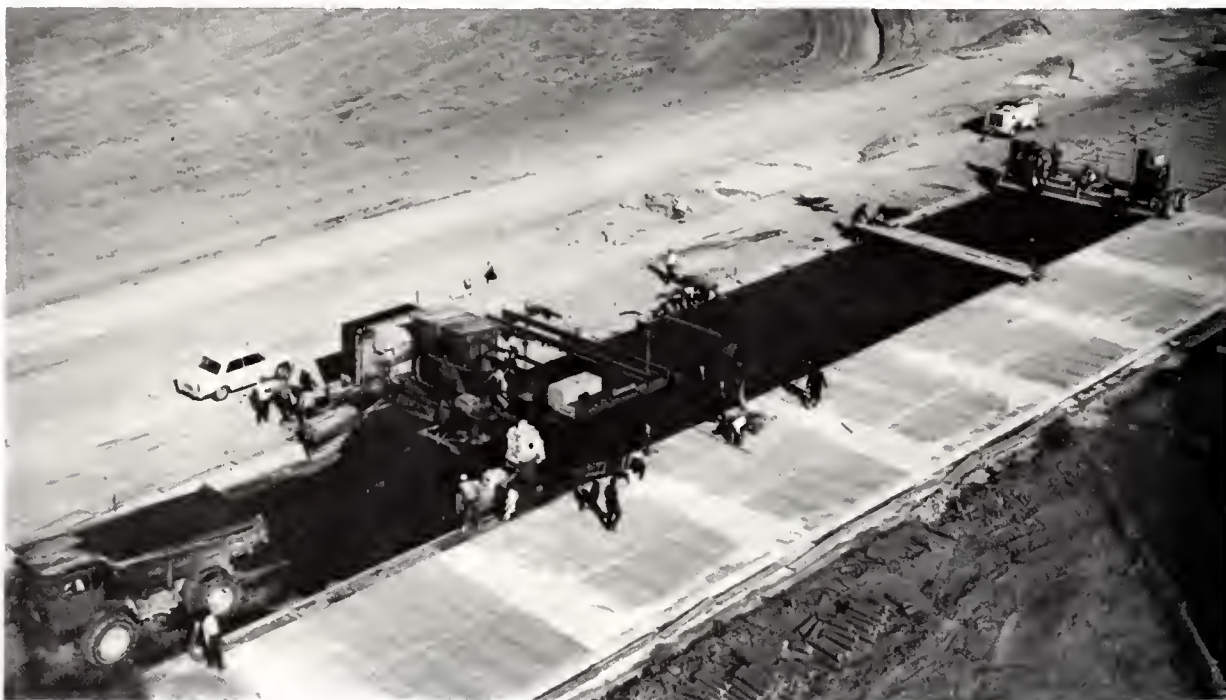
Construction d'une piste chaussée souple (*Jean-J. Moreau — Aéroport de Paris*)
